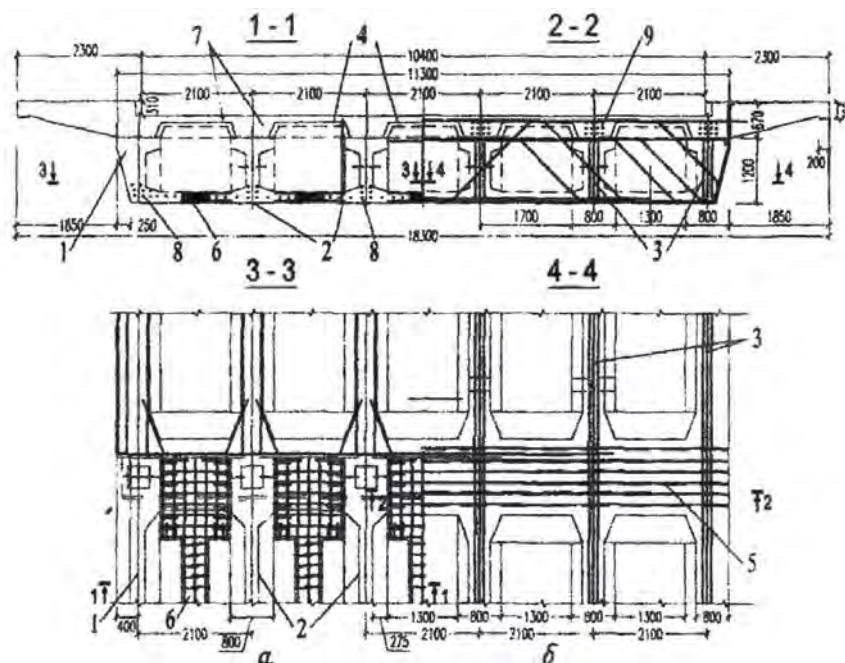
Фрагмент плану і перерізів прогонової будови:
